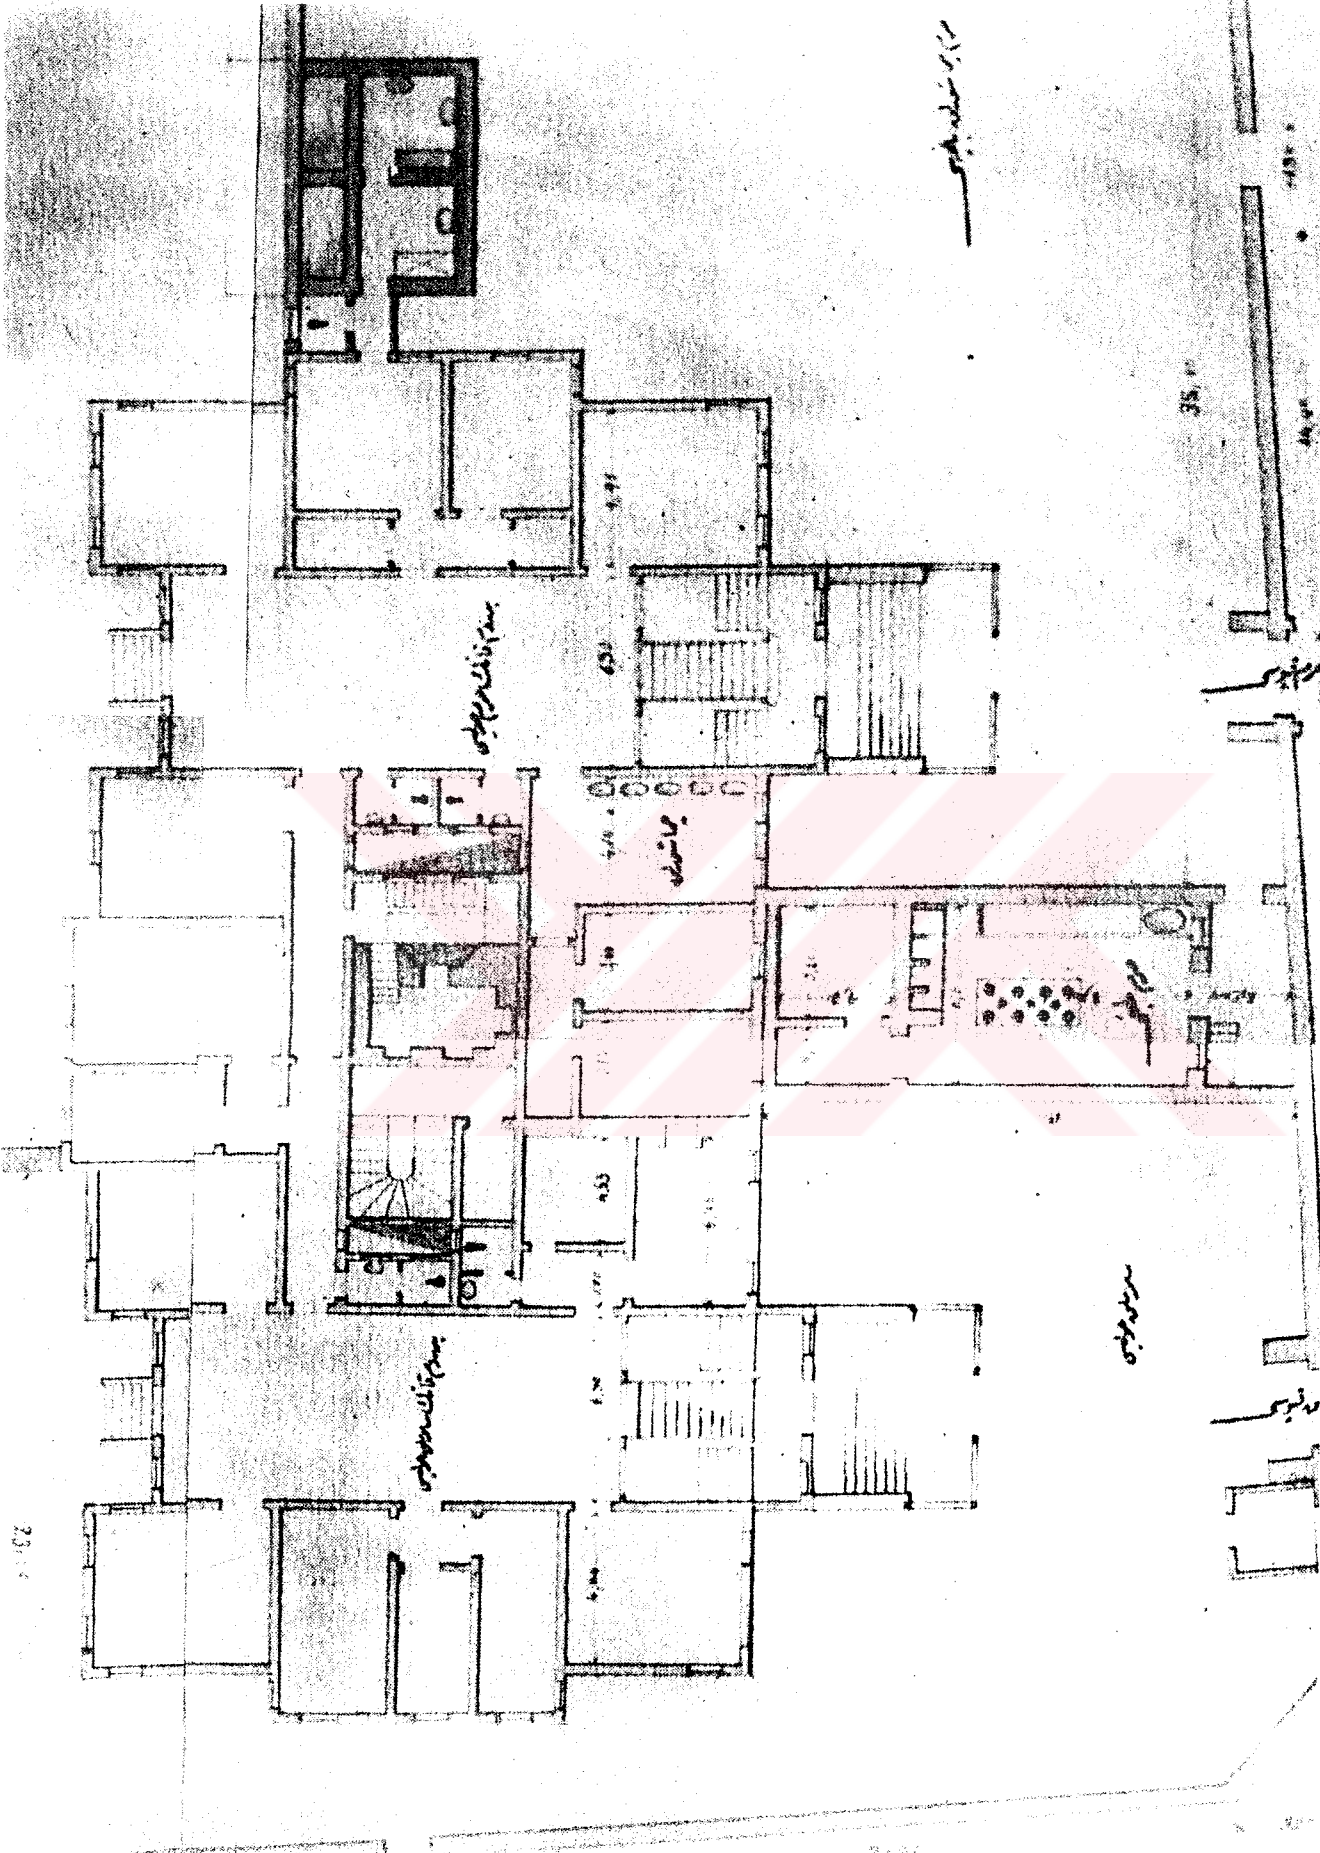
Halil Rifat Paşa K şk  Giriş Katı Planı,
